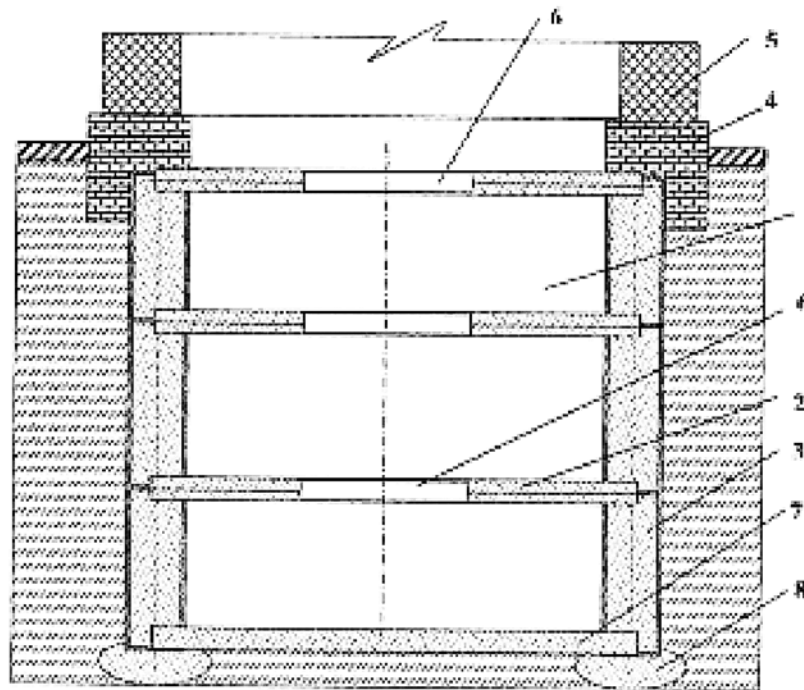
Схема влаштування підземного поверху: 1 - підземне приміщення; 2 - перекриття; 3 - палі (стіна в ґрунті); 4 - фундамент; 5 -реконструйована будівля; 6 - отвір; 7 - плита силової підлоги підземного поверху; 8 - опора подушка
